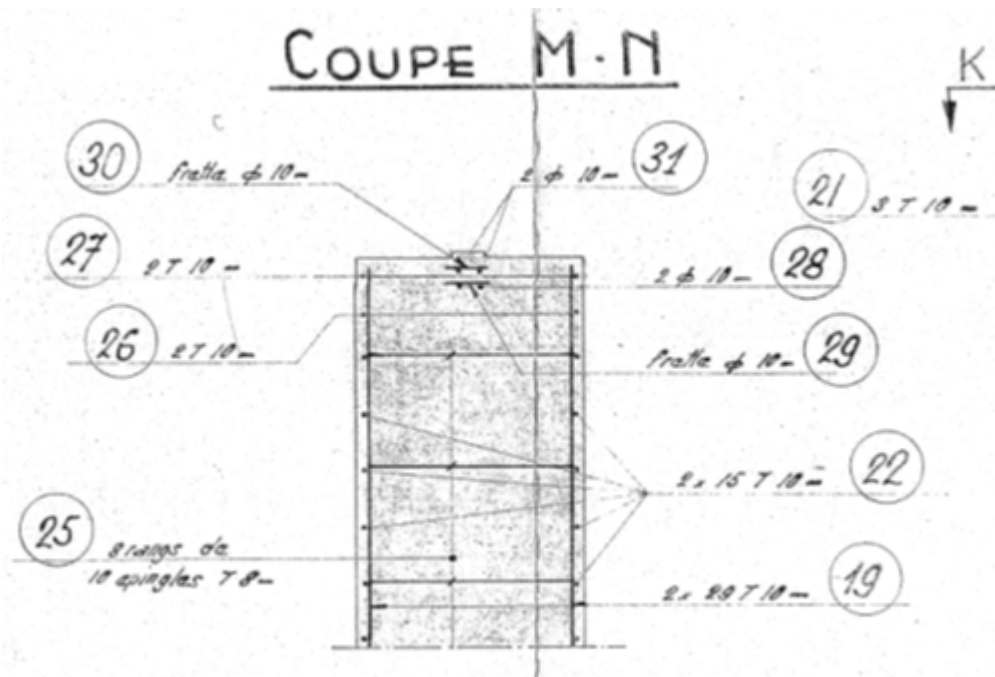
Détail du ferrailage de la tête de pile en coupe
